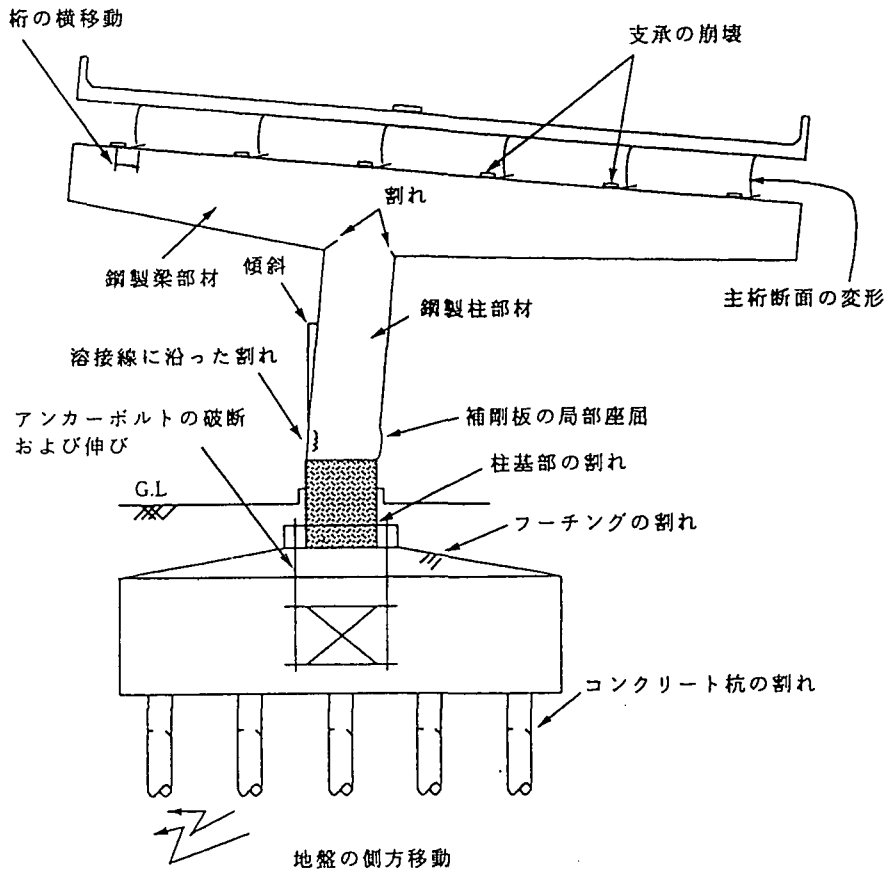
鋼製単柱橋脚、および鋼主桁端部の代表的な損傷のイメージ図
